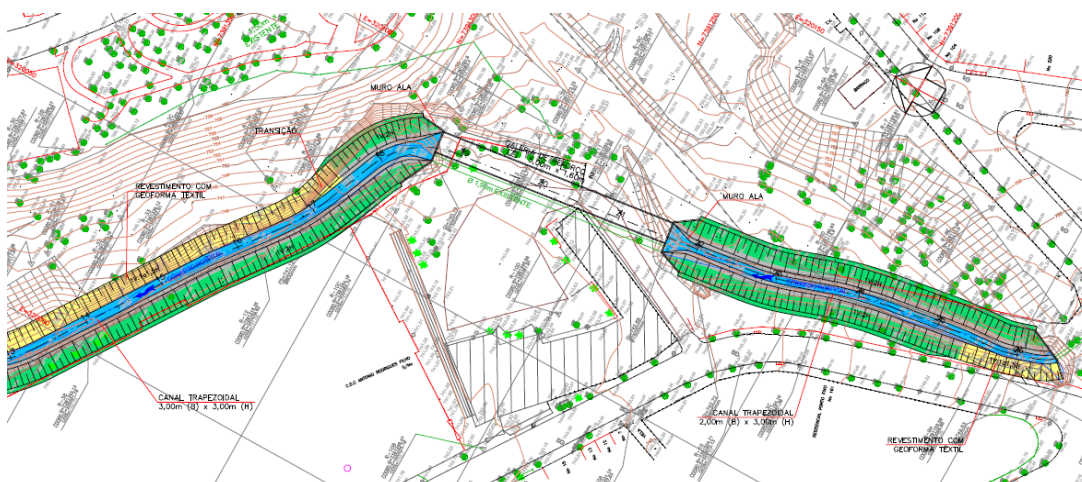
Projeto em planta demonstrando onde será efetuada a canalização do córrego.
